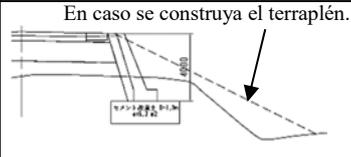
Plano de uniones de la carretera con los pilares del puente
